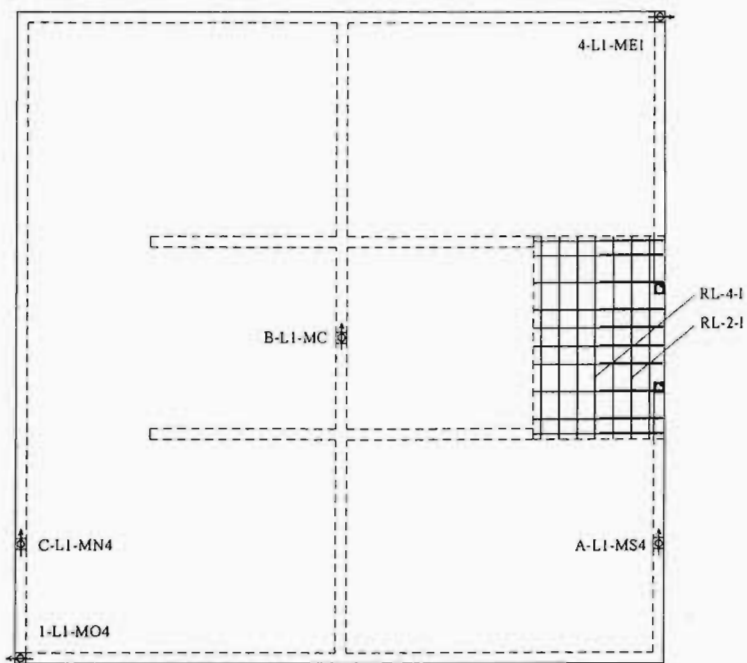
Instalación de acelerómetros y deformímetros en la losa del modelo
